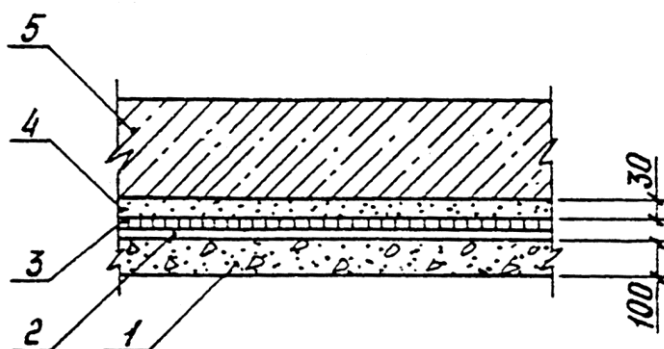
Гидроизоляция фундамента под оборудование
